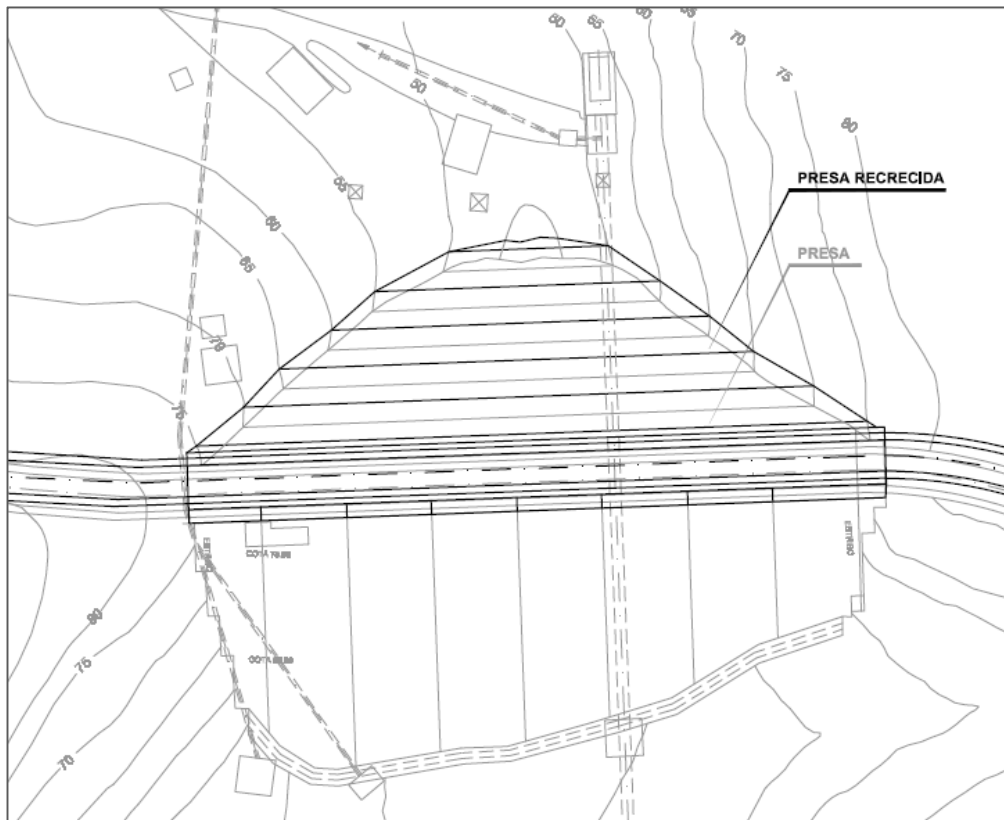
Planta Alternativa 2: Recrecimiento de la presa
